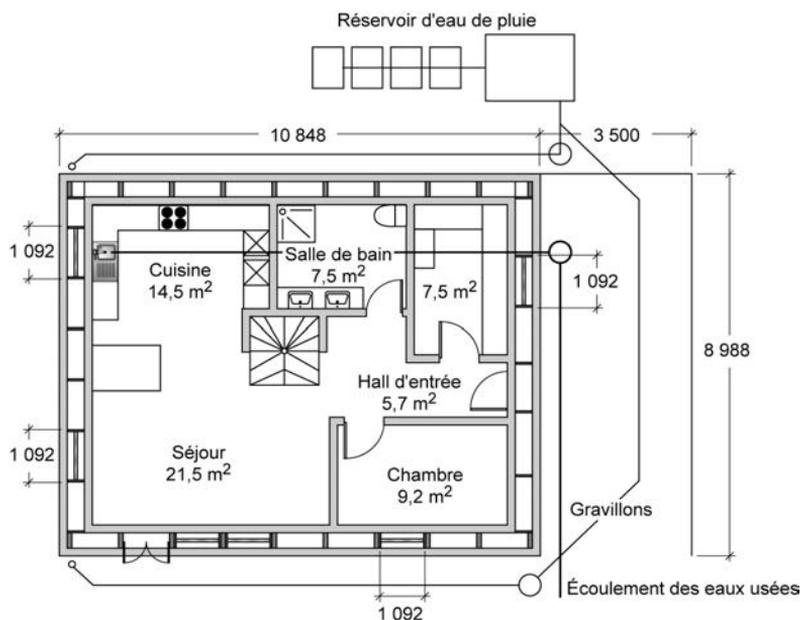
Plan du rez-de-chaussée (source : commune d'Egedal)
